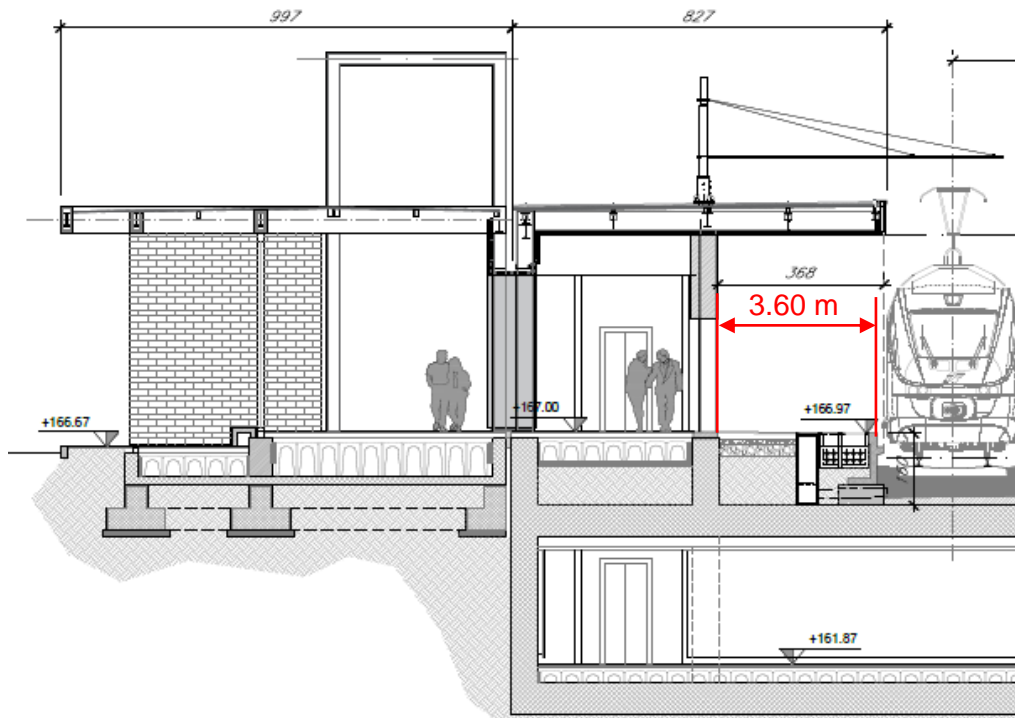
Sezione tipo stazione di Anguillara zoom su lato fabbricato viaggiatori
